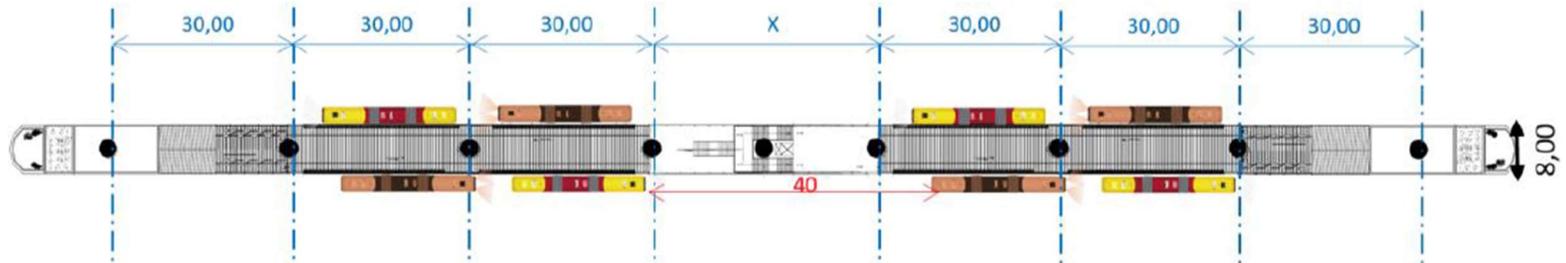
Distancia recomendada entre ejes de columnas para estaciones con integración a la PLMB
